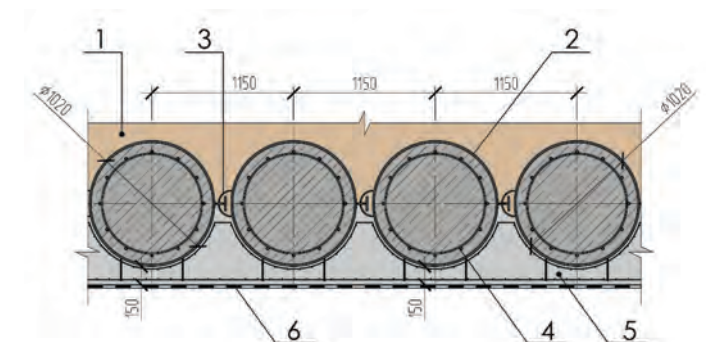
Конструкция защитного экрана из труб: 1 — грунт; 2 — стальная труба экрана; 3 — замковое устройство внешнего типа; 4 — арматурный каркас; 5 — выравнивающий слой из набрызгбетона; 6 — полимерная бесшовная гидроизоляция
